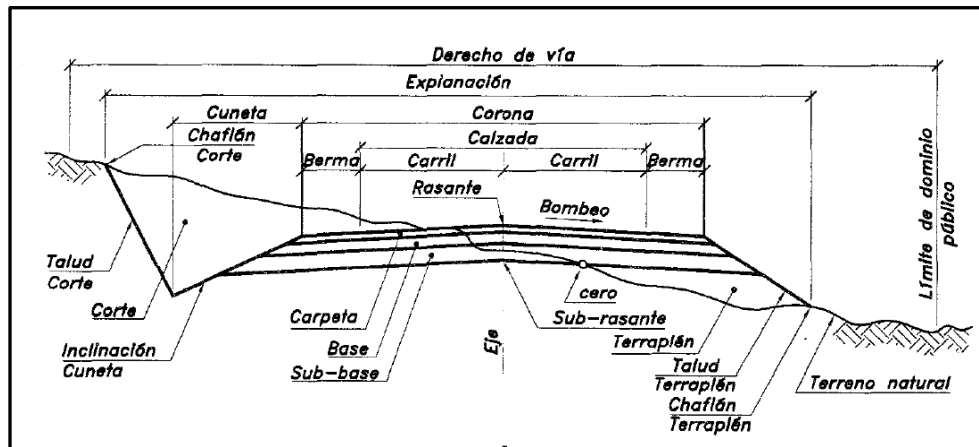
Sección transversal típica a media ladera. Cárdena G., J. (2008)
